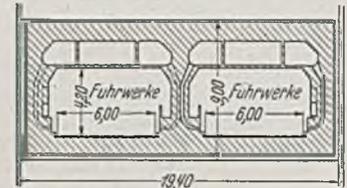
Querschnitt durch die Landstrecke des Tunnels.
